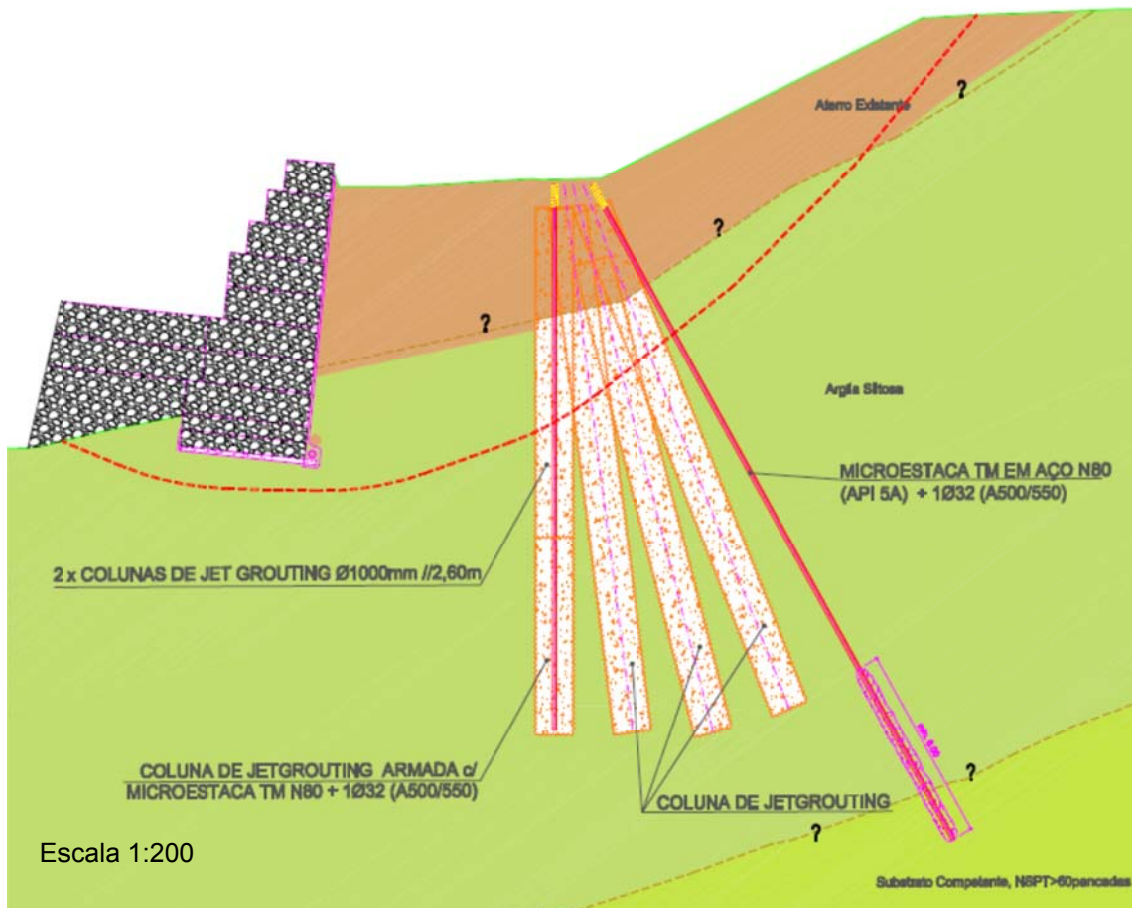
3ª Fase: Execução das colunas de jet grouting e das microestacas [3].
